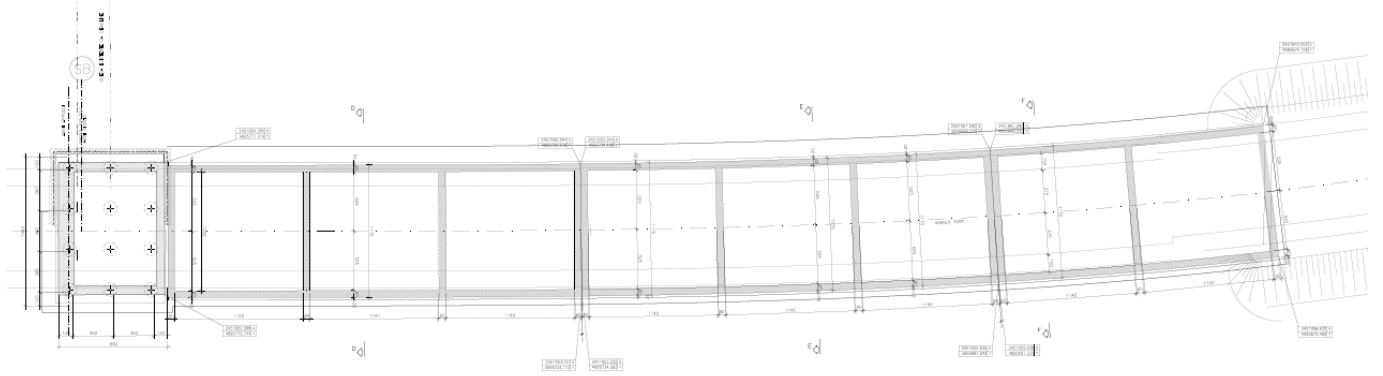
Pianta allo spiccatto - lato spalla SA
